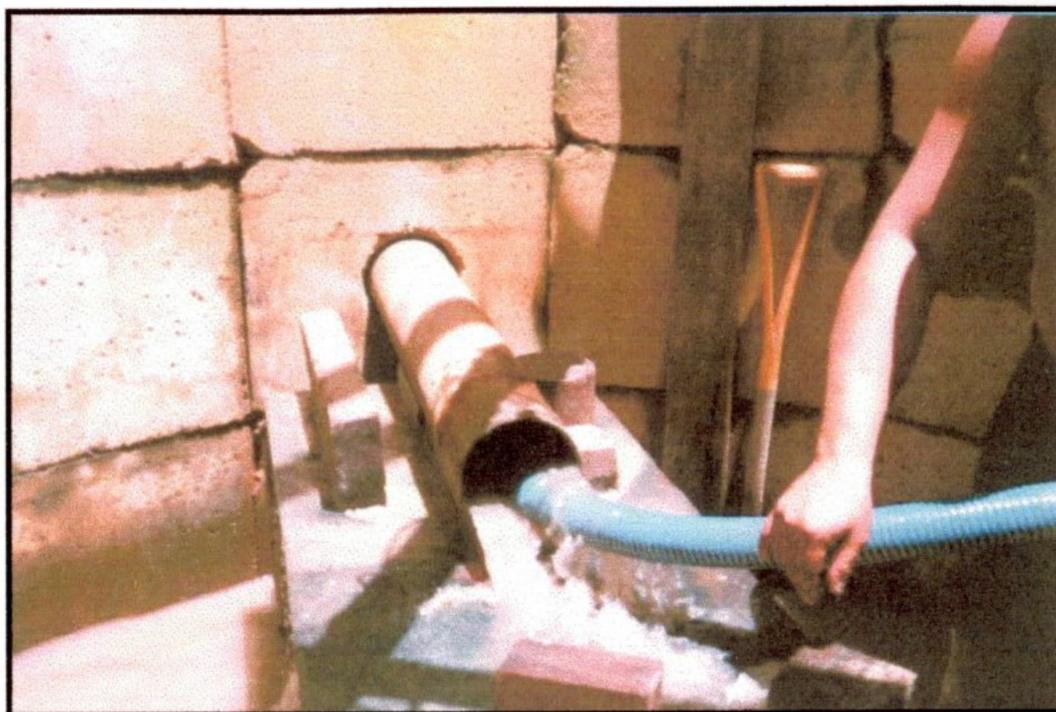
Sistema de limpeza dos tubos por carreamento hidráulico.
